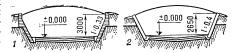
Полузаглублённые траншеи: 1 из кирпича; 2 — из железобетонных плит.
